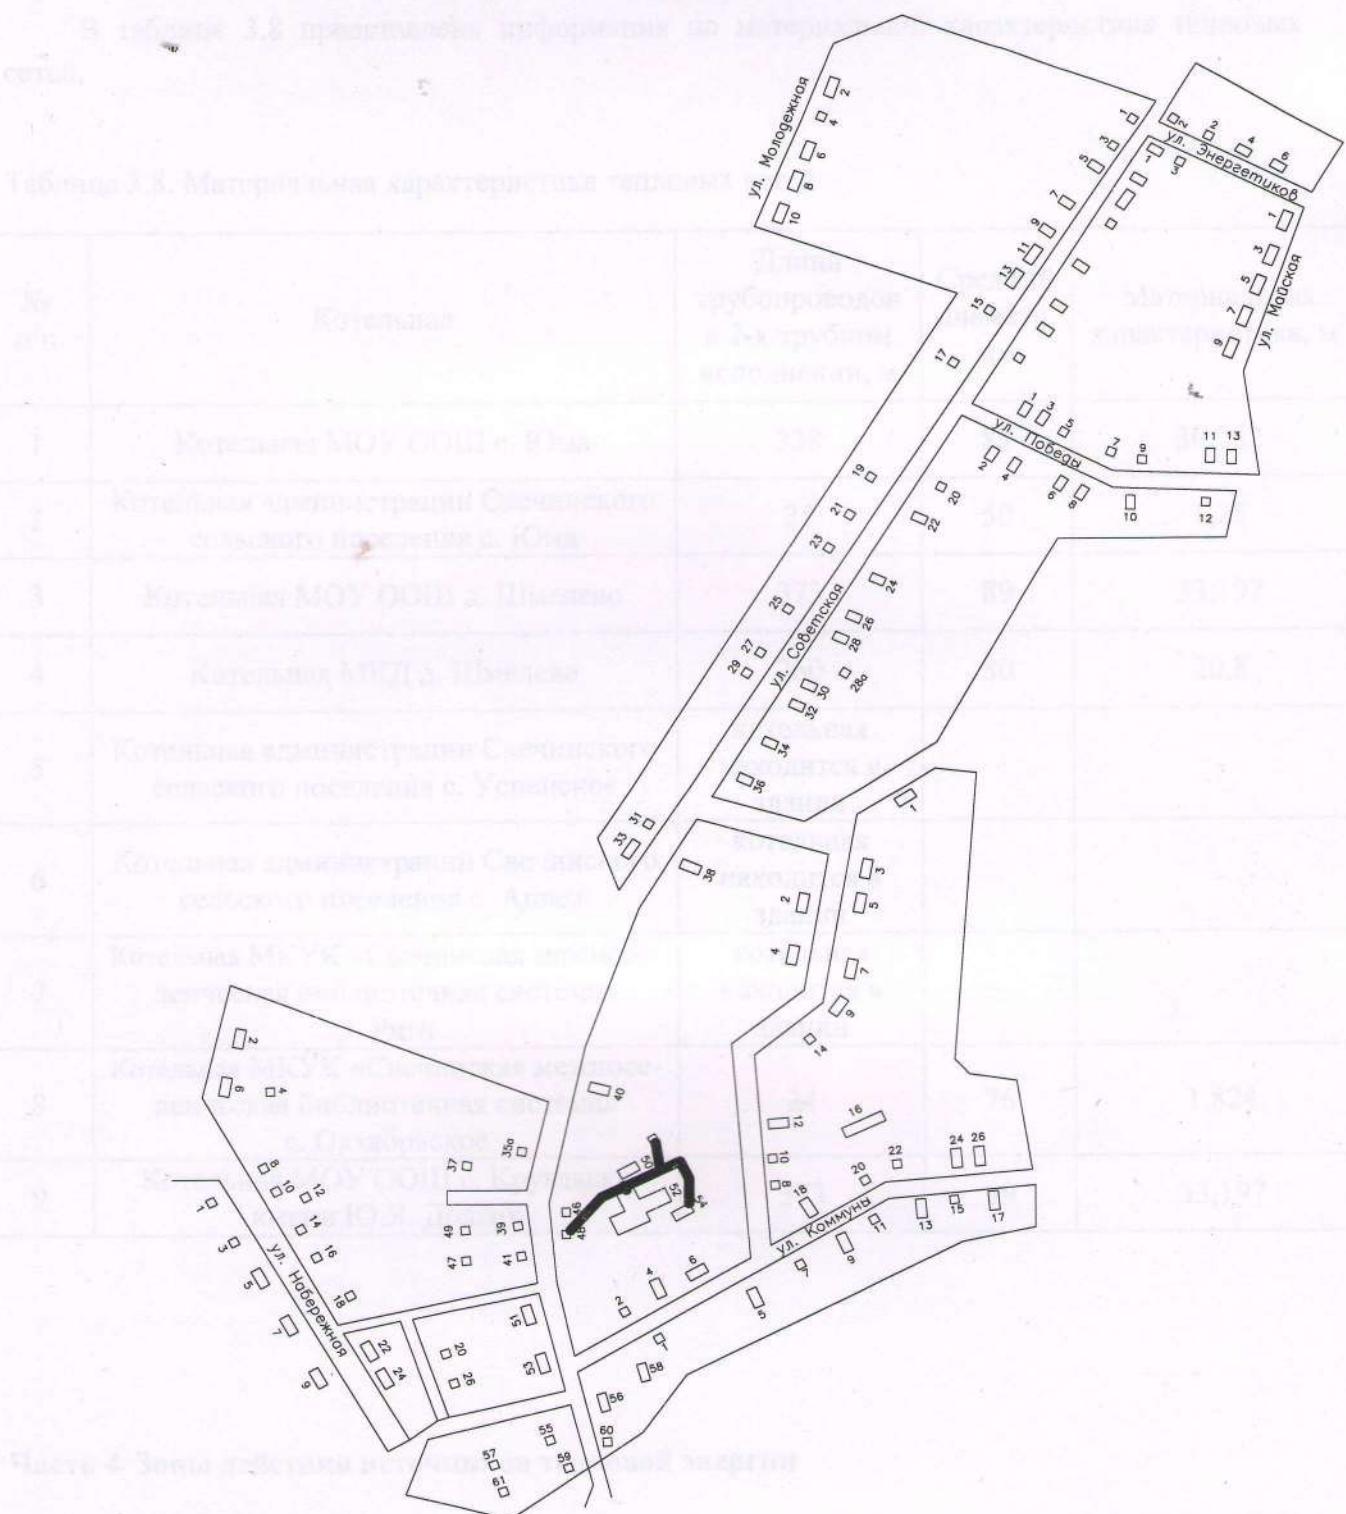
Схема теплоснабжения от котельной МОУ ООШ с. Круглыки имени Ю.Я. Долгих
